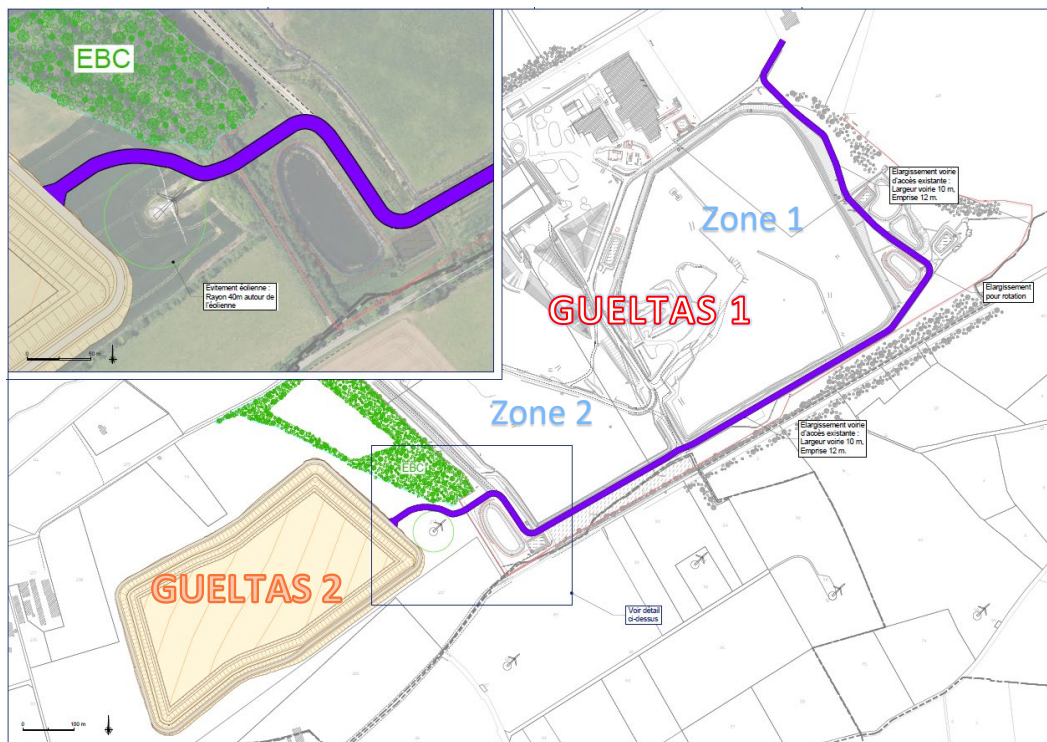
Plan d'accès principal au site de GUELTAS 2
